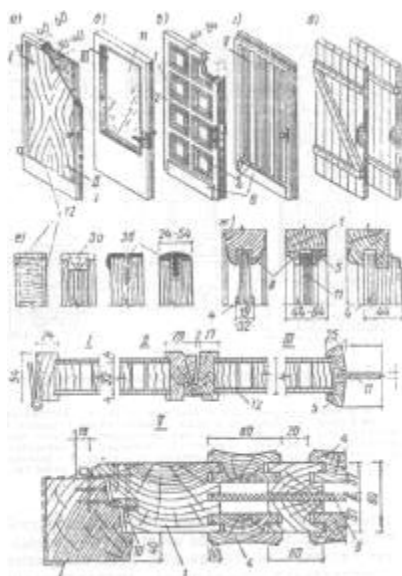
Полотна деревянных дверей: *а* — щитовое глухое; *б* — остекленное; *в* — филенчатое; *г* — филенчатое повышенной звукоизоляции; *а* — плотничные двери на планках и шпонках; *е* — обкладка полотен щитовых дверей; *ж* — установка филенок в обвязку; *1* — обвязка дверного полотна; *2* — средник; *3* — обкладка дверей (За — деревянные на клею; 3б — пластмассовые); *4* — филенка; *5* — штапик; *6* — плинтус; *7* — нащельник; *8* — калевка; *9* — звукоизоляционная прокладка; *10* — резиновый уплотнитель притвора; *11* — стекло; *12* — офанеровка или оклейка пластиком
